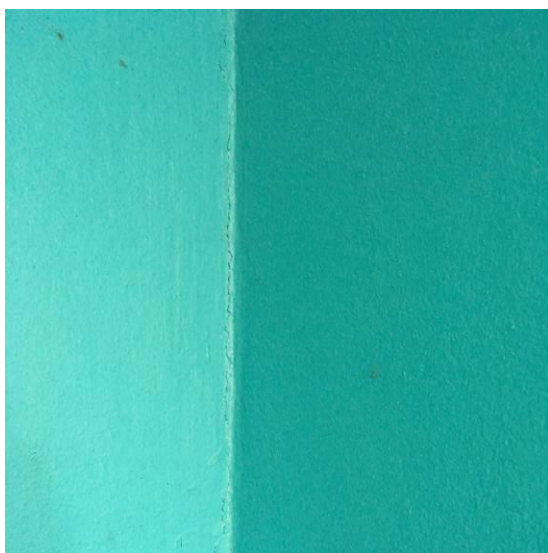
Bâtiment A RDC, salle info 1 - Paroi verticale : D2 - Fissuration modérée.
